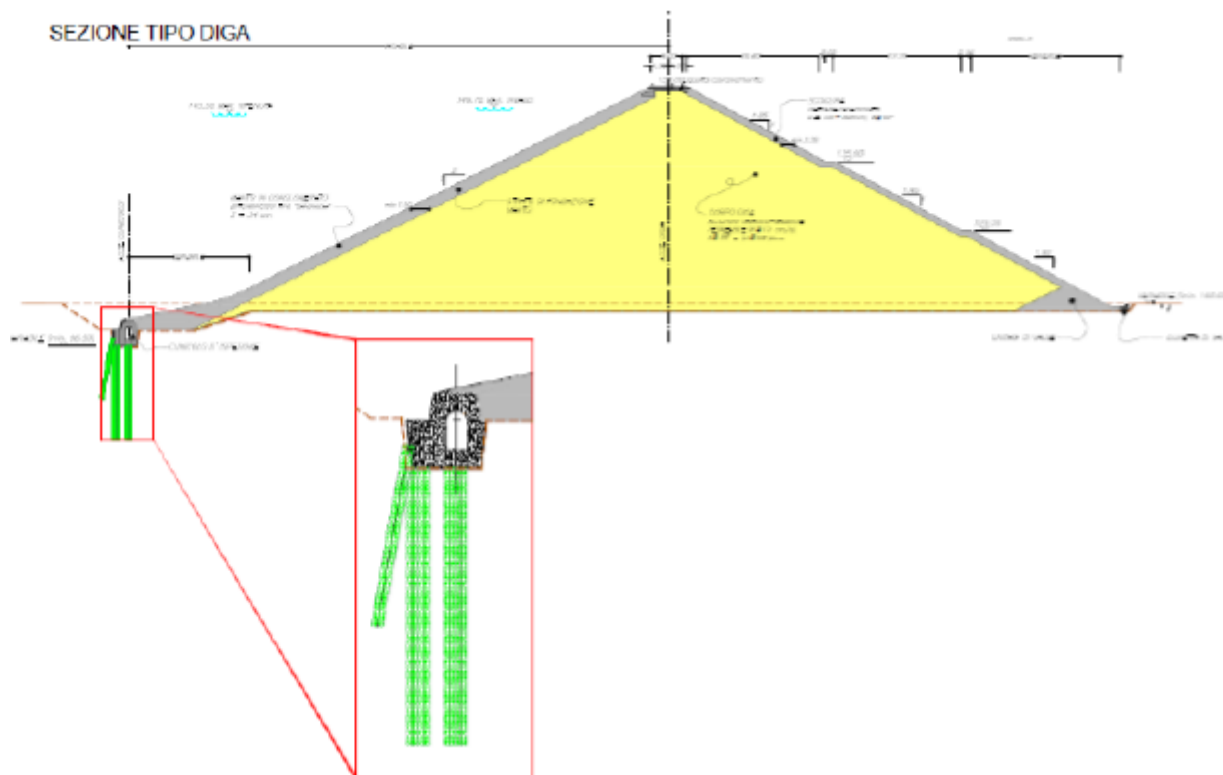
Geometria dell'intervento di inspessimento della cortina
